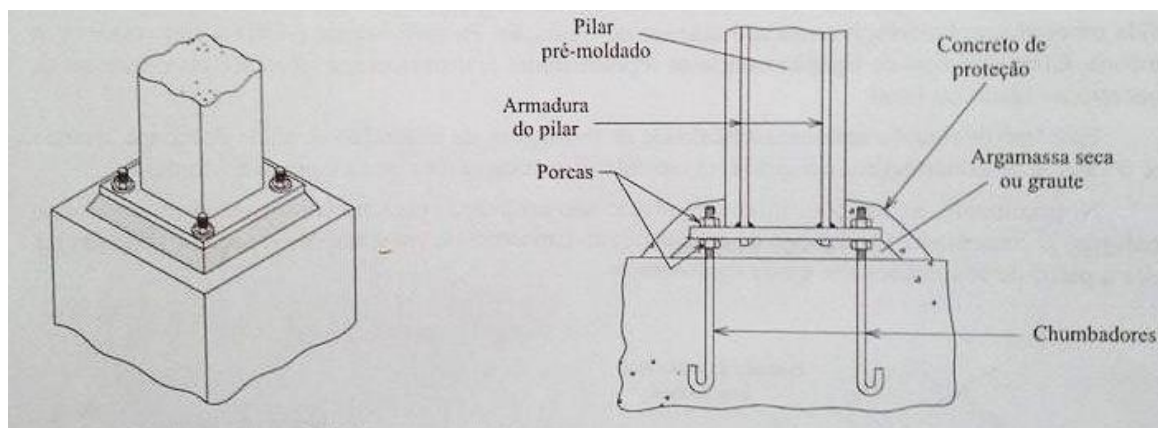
Ligação pilar - fundação por meio de chapa de base
